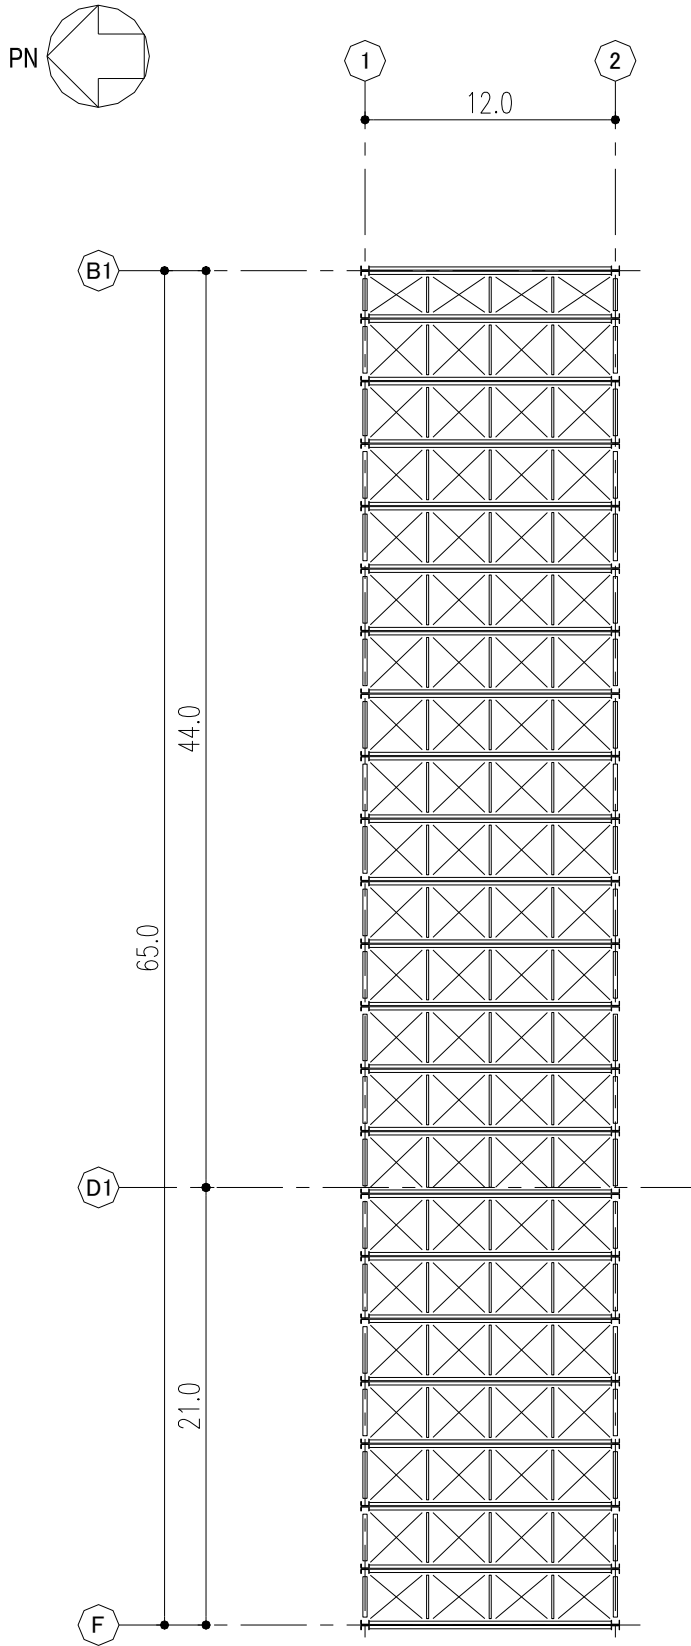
設備棟 屋根平面図 設計 G.L. +6.6 (単位 : m)
